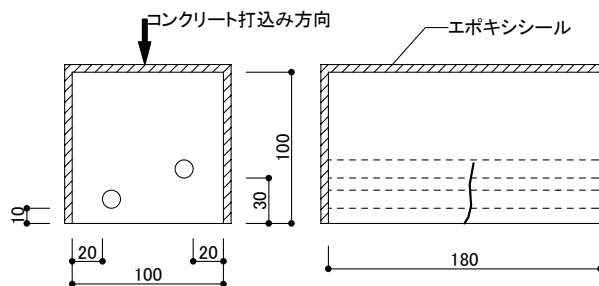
非貫通ひび割れ試験体(試験体タイプ B)
